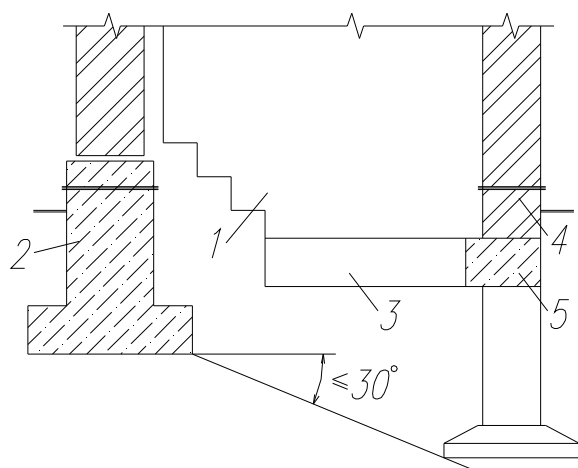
Примыкание новых фундаментов ниже подошвы существующих
